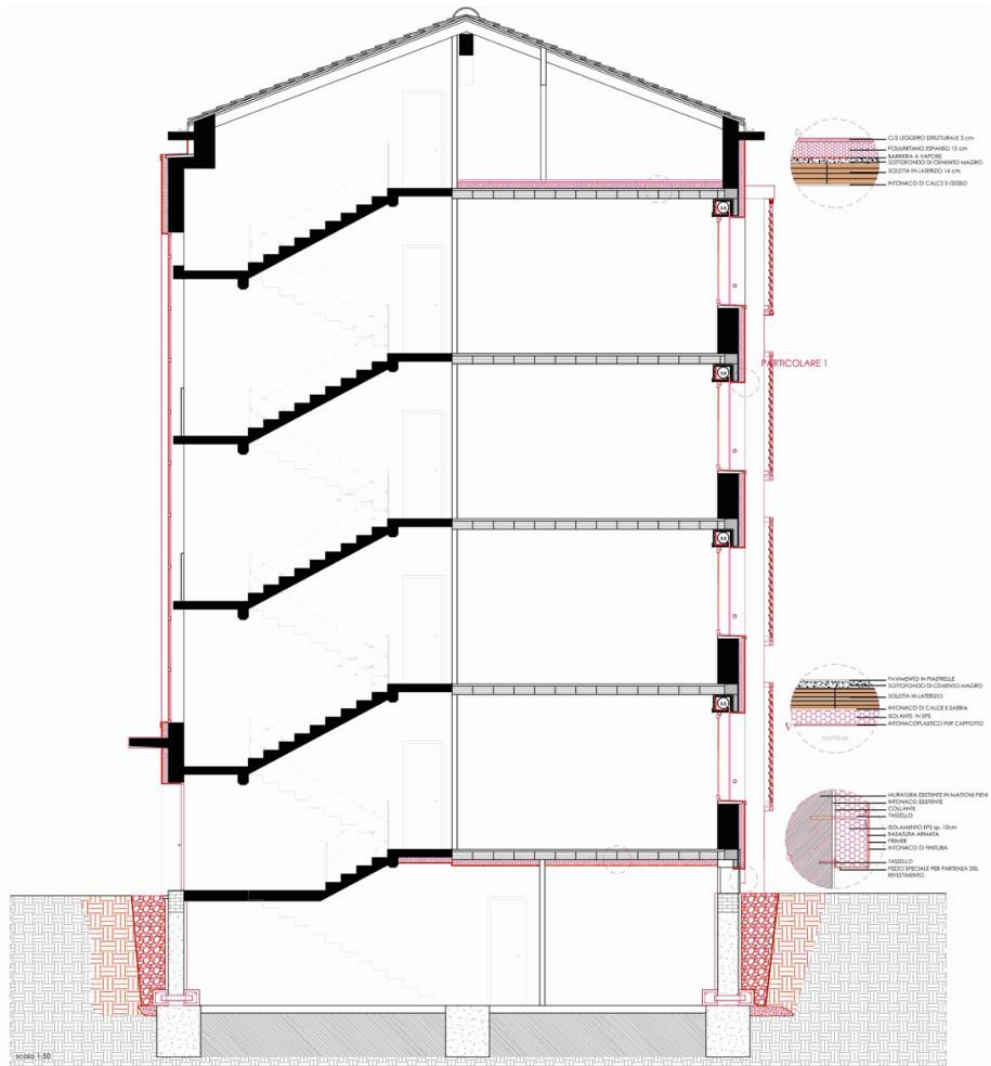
Sezione di progetto con aggiunte e rimozioni
